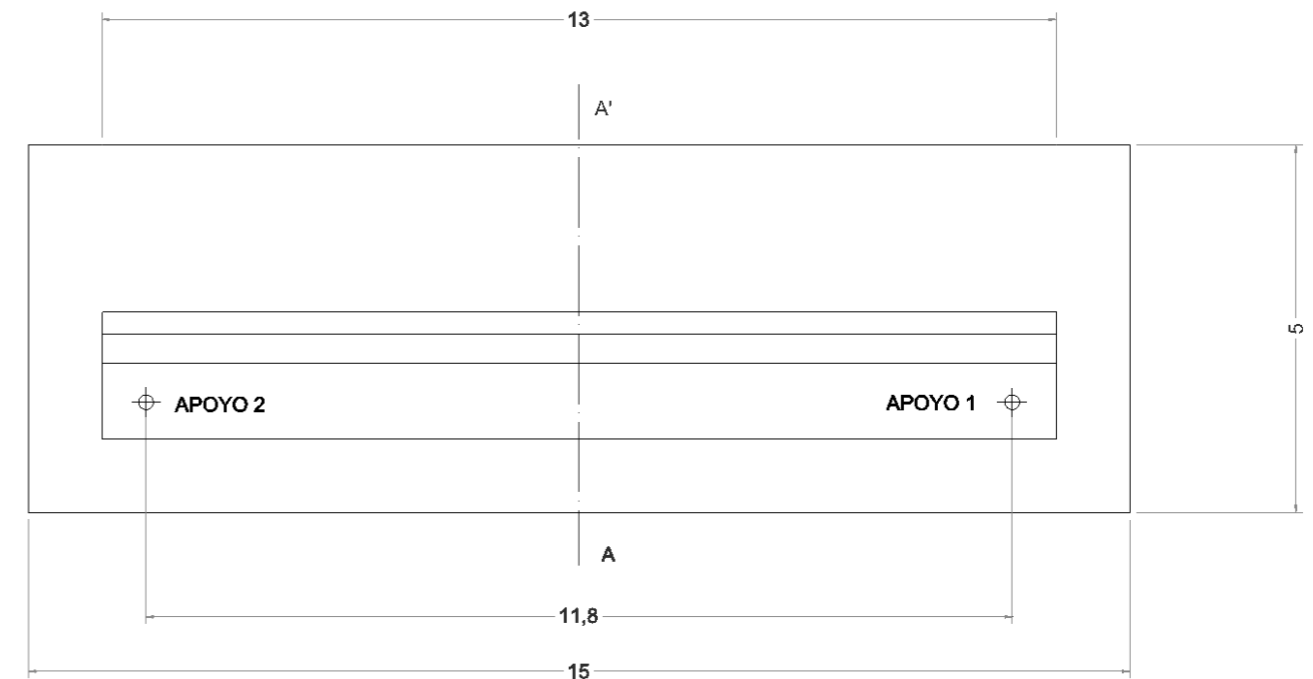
Planta estribo, unidades en m (Fuente: Elaboración propia)
